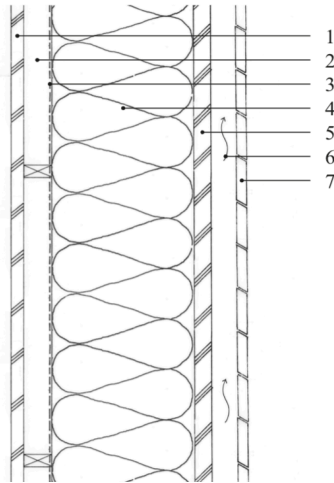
Wandaufbau Holzbauponstruktion (Deplazes, 2008, S. 103)
